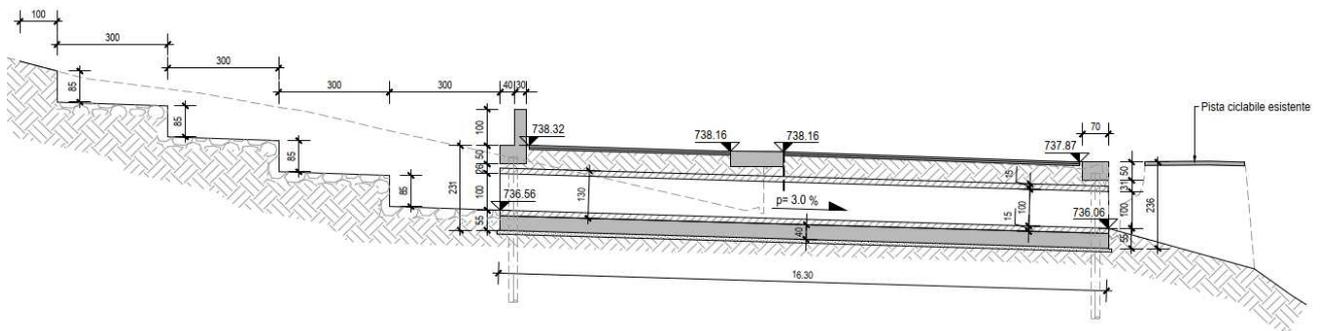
Profilo sistemazione idraulica a monte dell'attraversamento 2 e manufatto di attraversamento.
